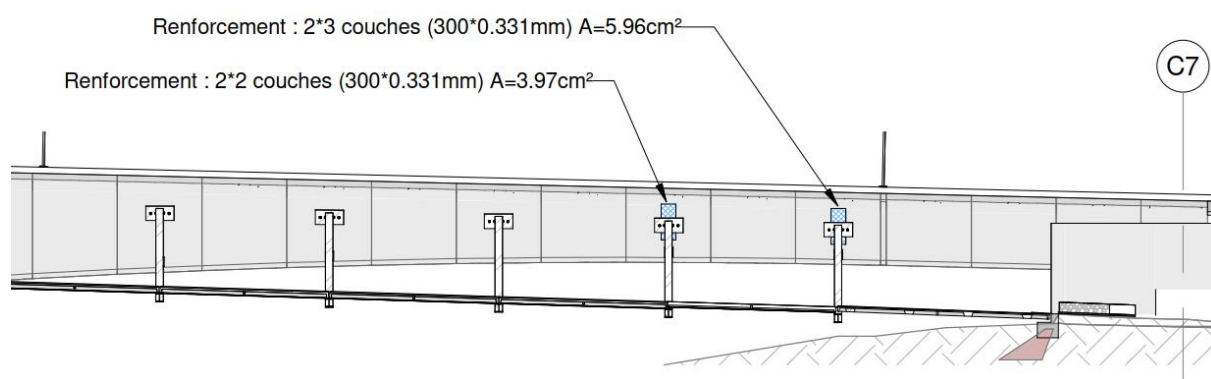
Renforcement en tissu de carbone sur travée de rive droite - extrait du cahier de plan technique PRO
